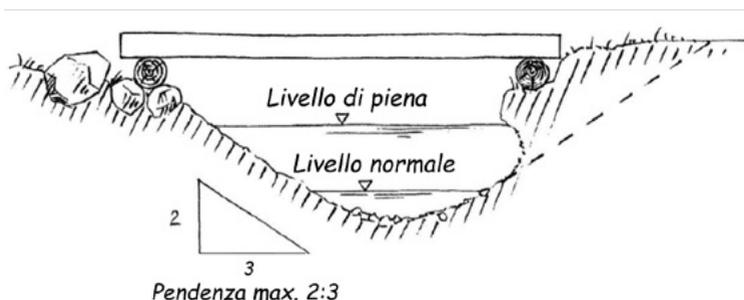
Schizzo di spalle ben posizionate (USTRA)
